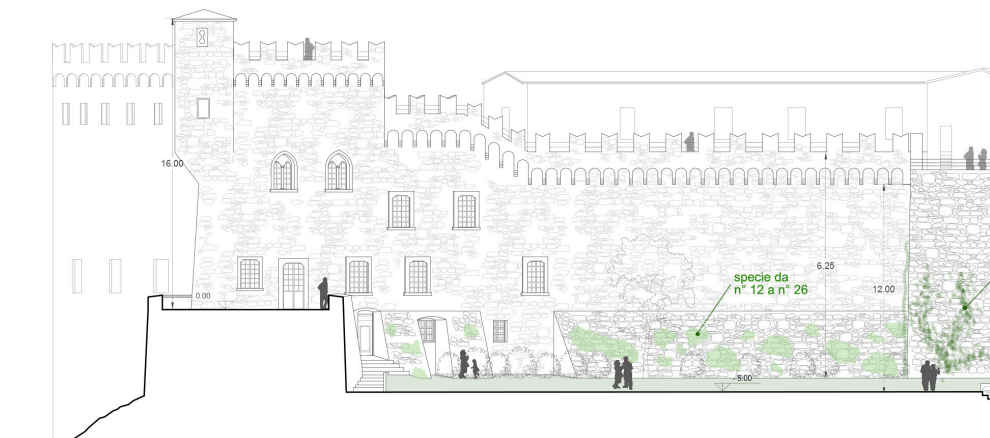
Sezione sul bastione dell'orologio e sul giardino delle ortensie. Estratto dalle tavole di Tesi (tav. 5)
